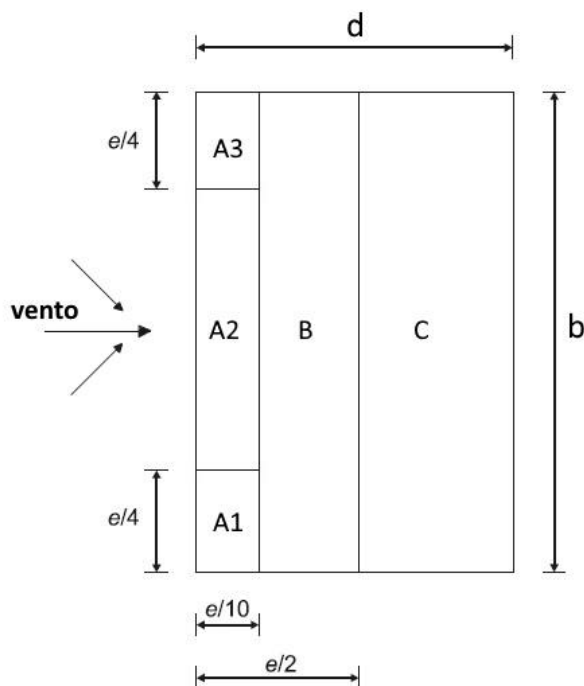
Divisão da cobertura em planta (Fonte: adaptado [29])
